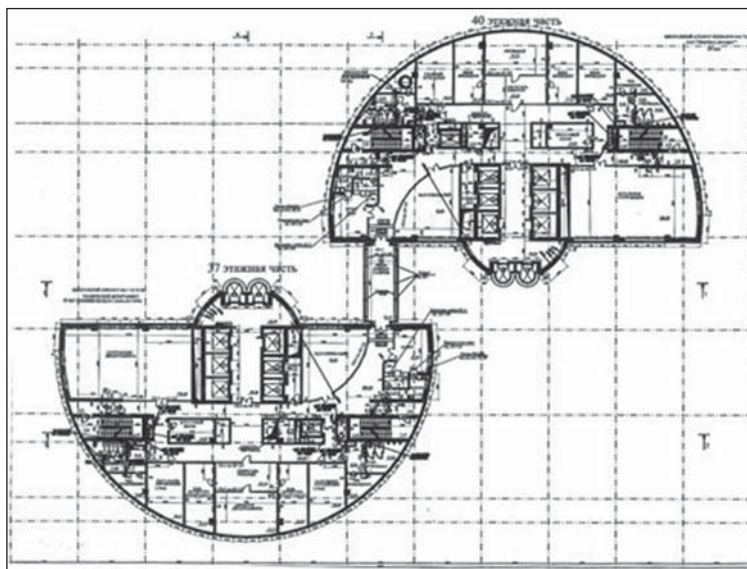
План на отм. 109,50 м. (28 этаж), справа верхний план 40 этажная высотка, слева внизу 37 этажная высотка.
